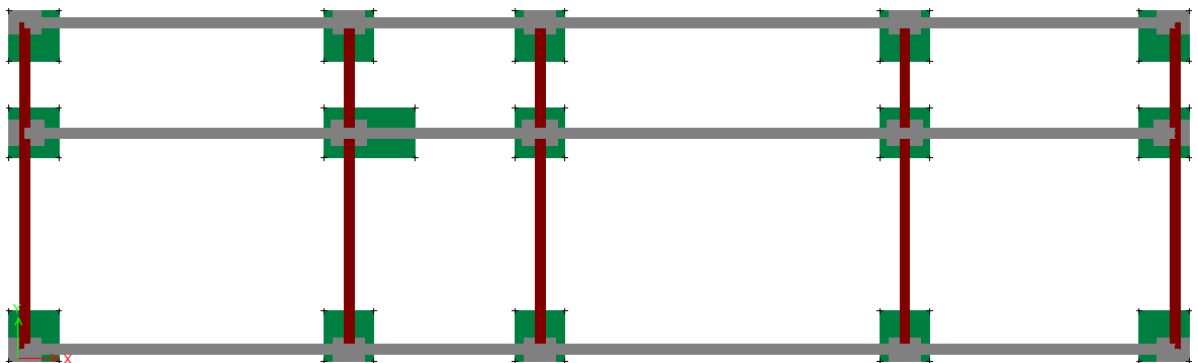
Análisis de la Sub Estructura del Sistema Estructural Mixto– Vista en planta.
